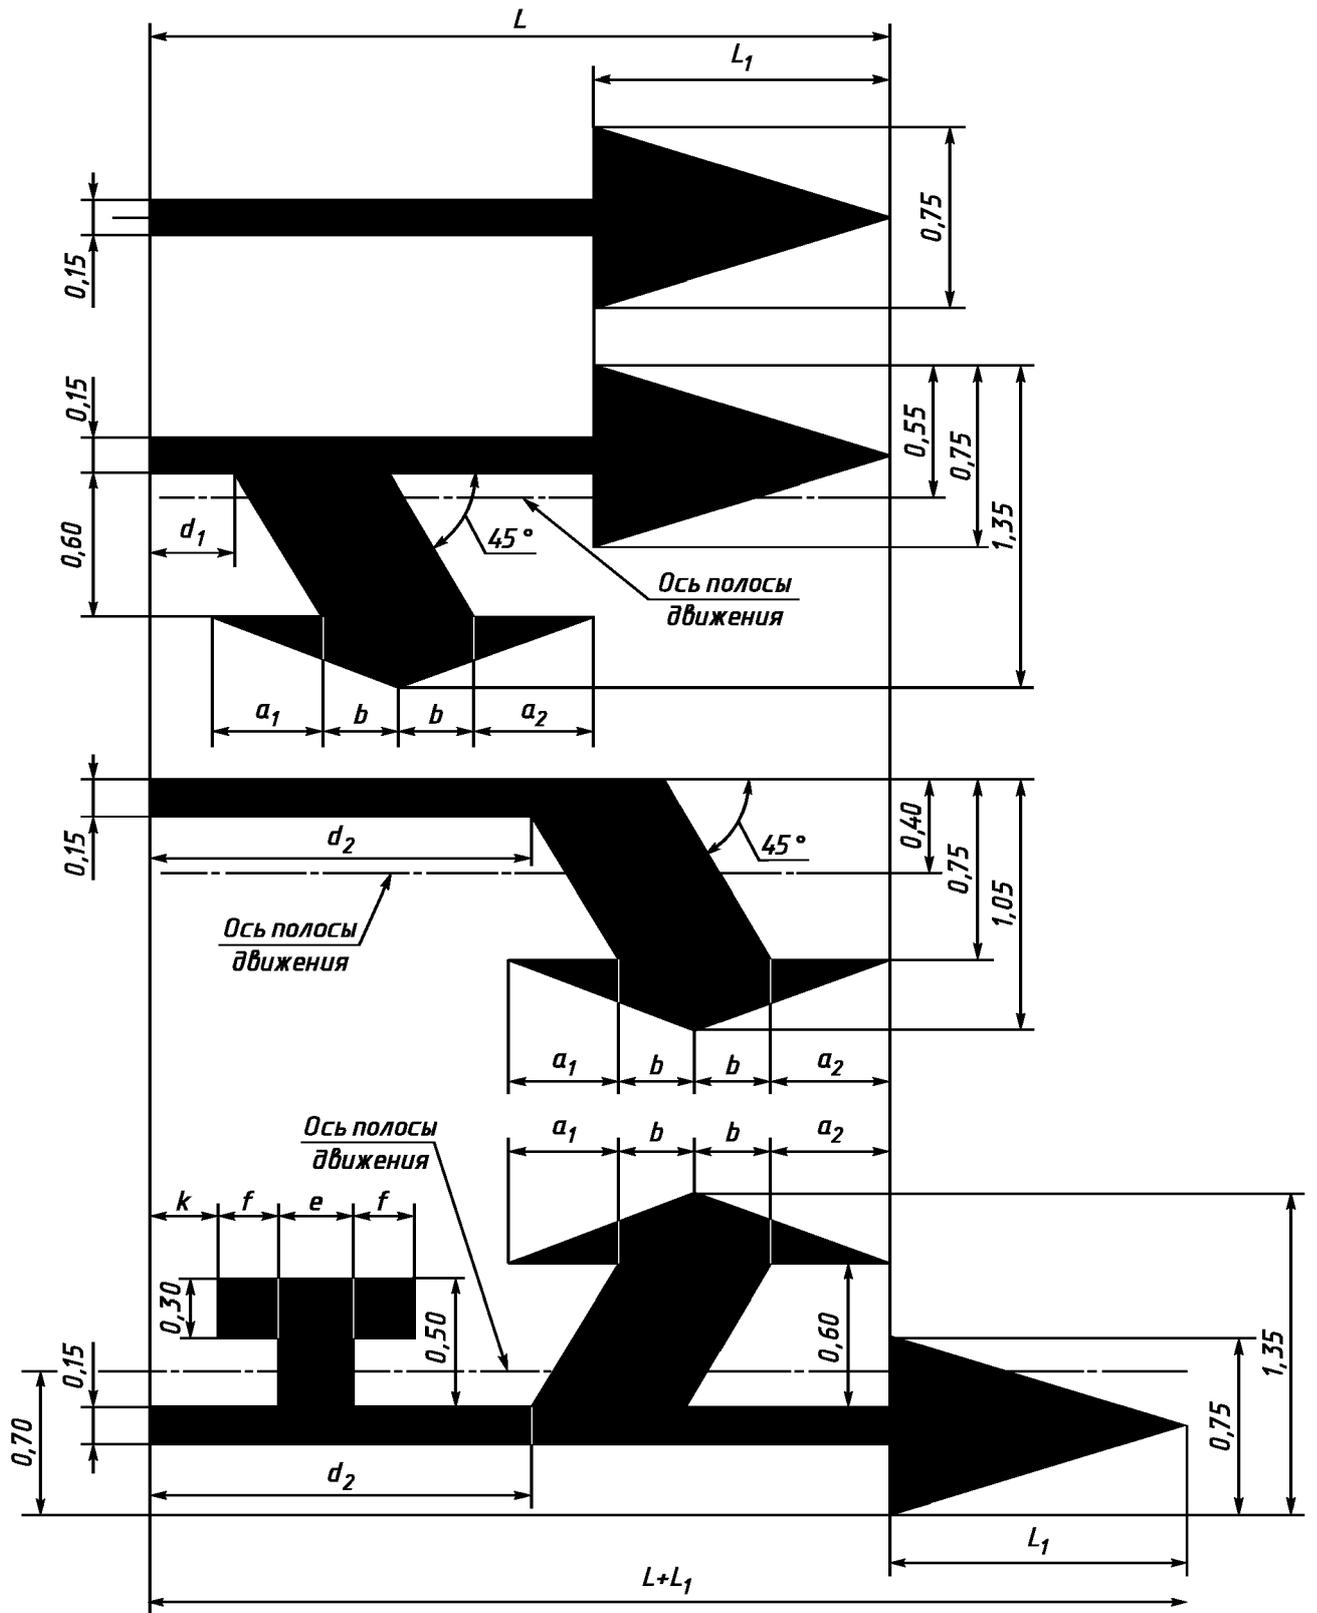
Форма и размеры стрел разметки типа 1.18
